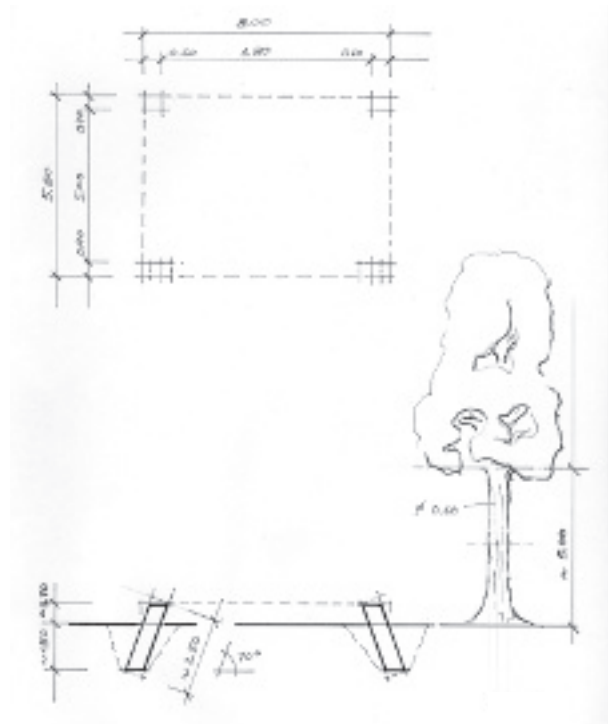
Schéma d'utilisation d'un arbre pour la construction d'un bâtiment à poteaux inclinés (W.T.).
